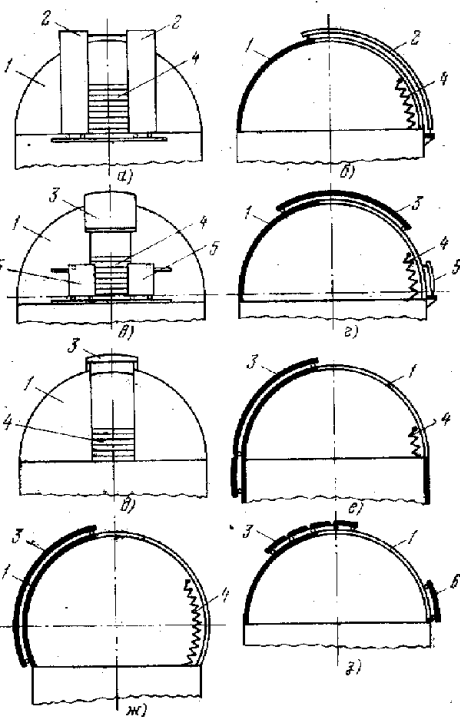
Механизмы закрывания щели. а, б — щель закрывается створками (вид спереди и сбоку); в, г — щель закрывается забралом с маленькими створками (вид спереди и сбоку); д, е — гибкое забрало (вид спереди и сбоку); ж — жесткое забрало на куполе, превышающем полусферу (вид сбоку); з — расщепное гибкое забрало (вид сбоку).
